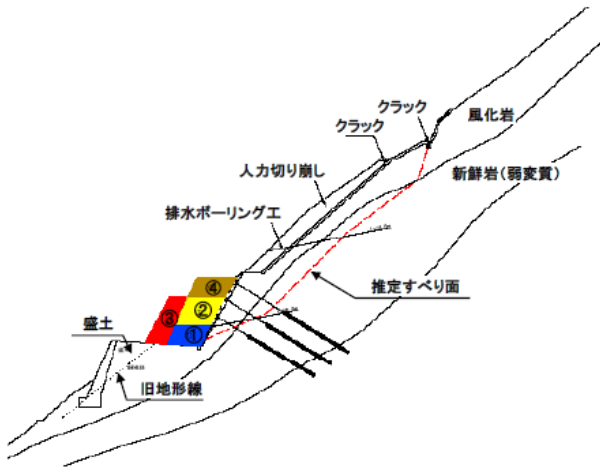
No.8 地すべりの押え盛土施工図（縦断面図）
